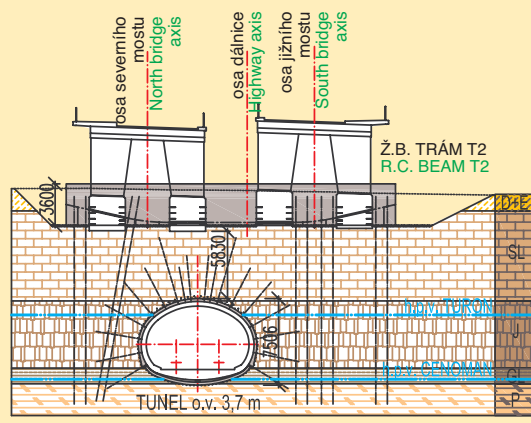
Podélný řez osou tunelu pod mostními objekty
